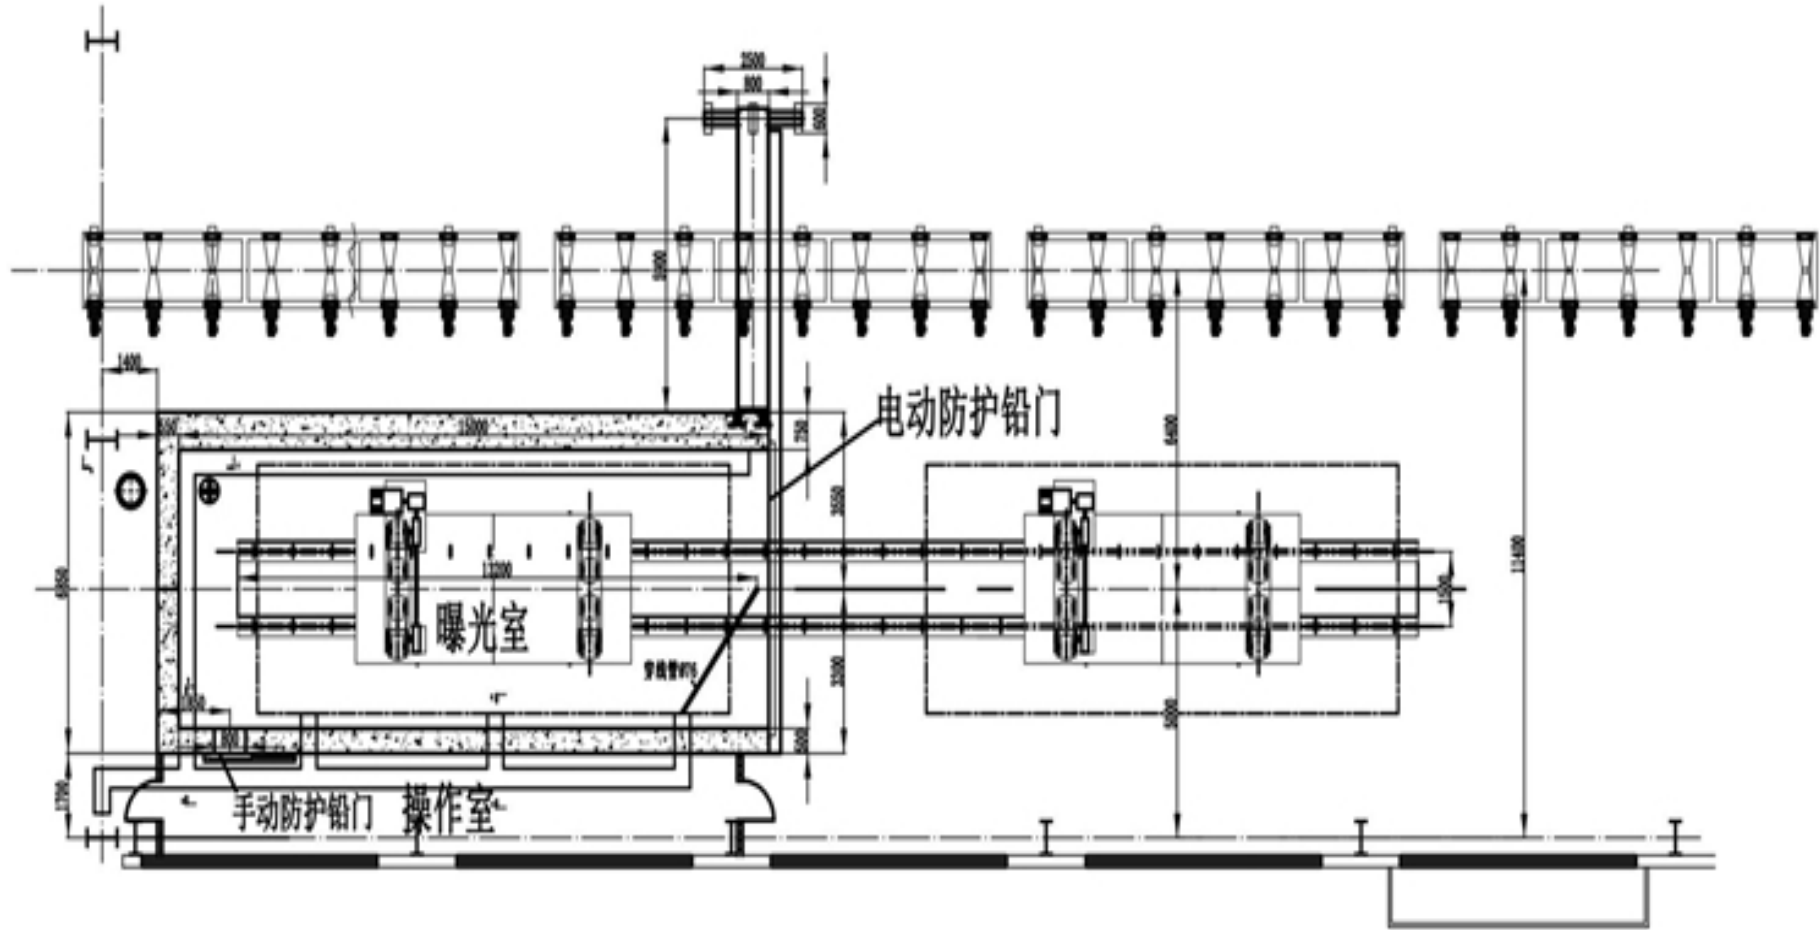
卷制焊管探伤室（固定场所移动高频 X 射线探伤机）平面布置图
